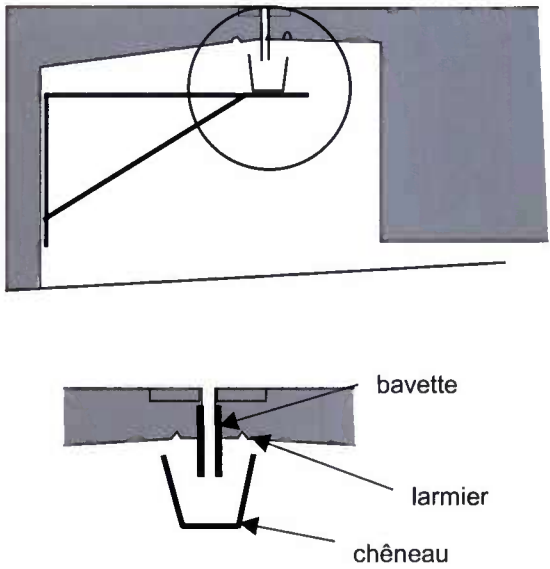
Collecte des eaux sous les joints de chaussée
